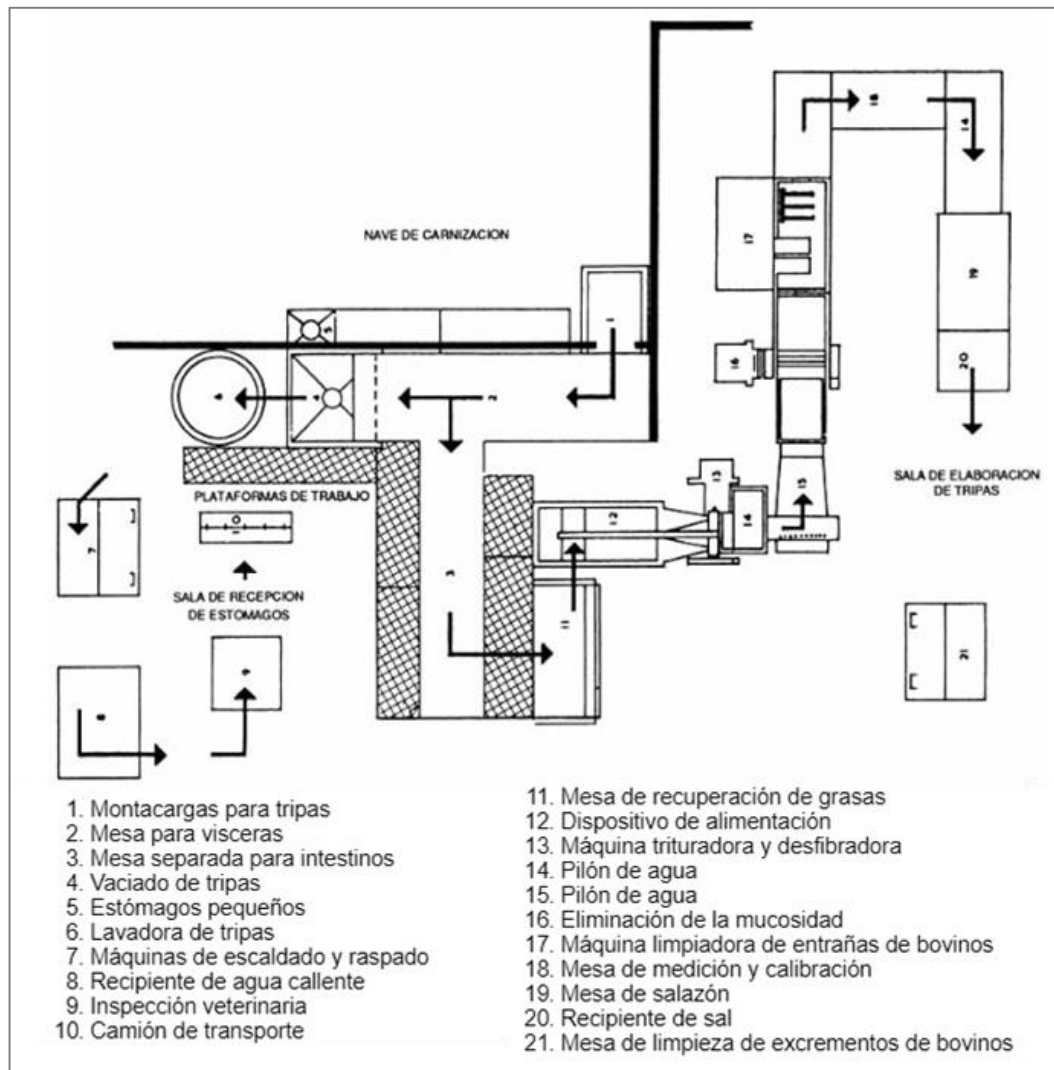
Planta de sección de tratamiento de estómagos y tripas de bovino.
